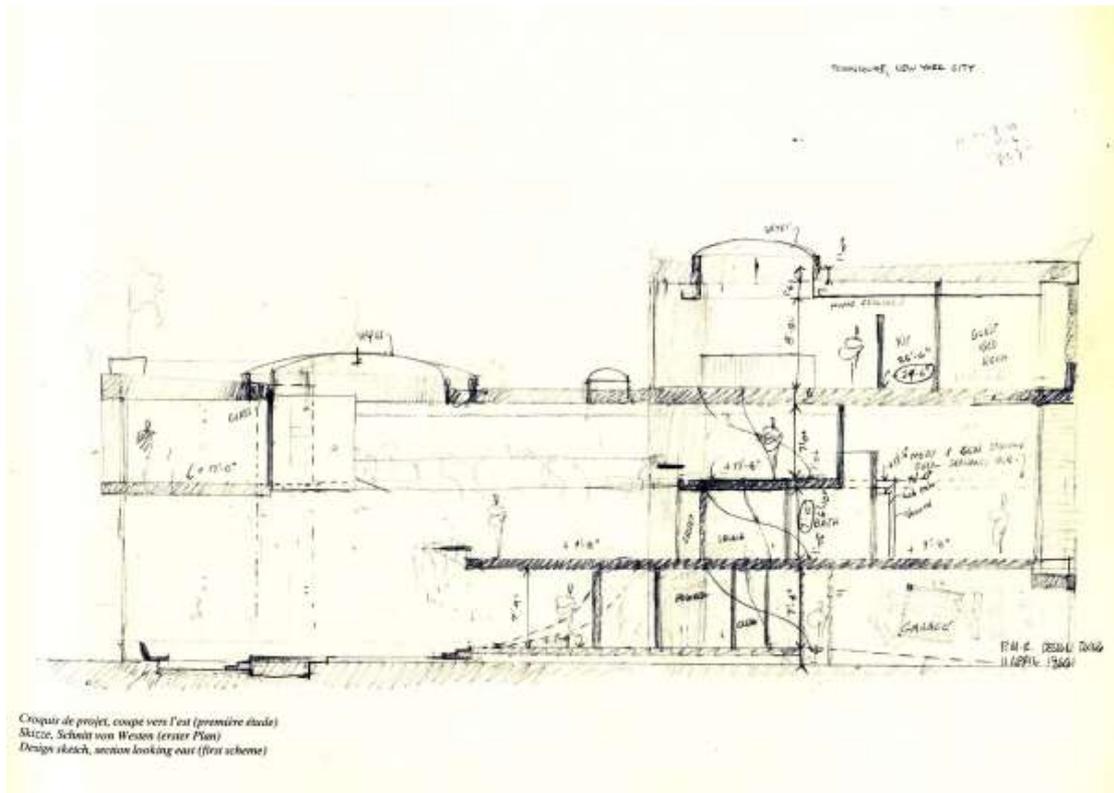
« *Townhouse, New York City, Croquis de projet, coupe vers l'est (première étude)* »¹⁸³
